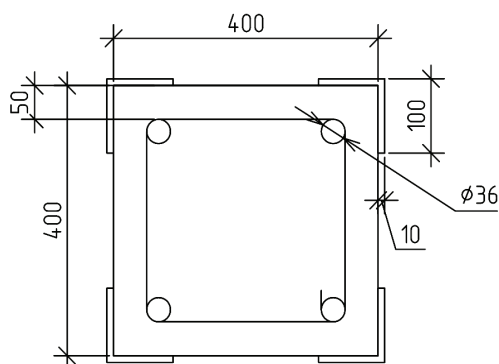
Схема колонны квадратного сечения с жестким внешним армированием (вариант 3) – квадратное сечение с обоймой из 4 уголков.
